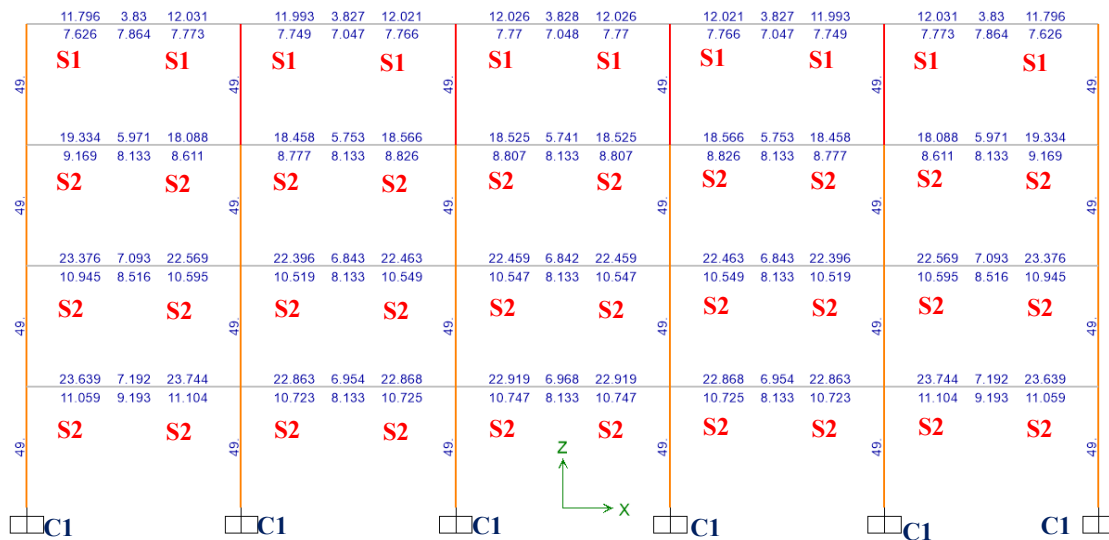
Área de acero requerido (típico) en pórticos exteriores (en cm²), debido a la flexión y flexo-compresión en vigas y columnas, respectivamente.
